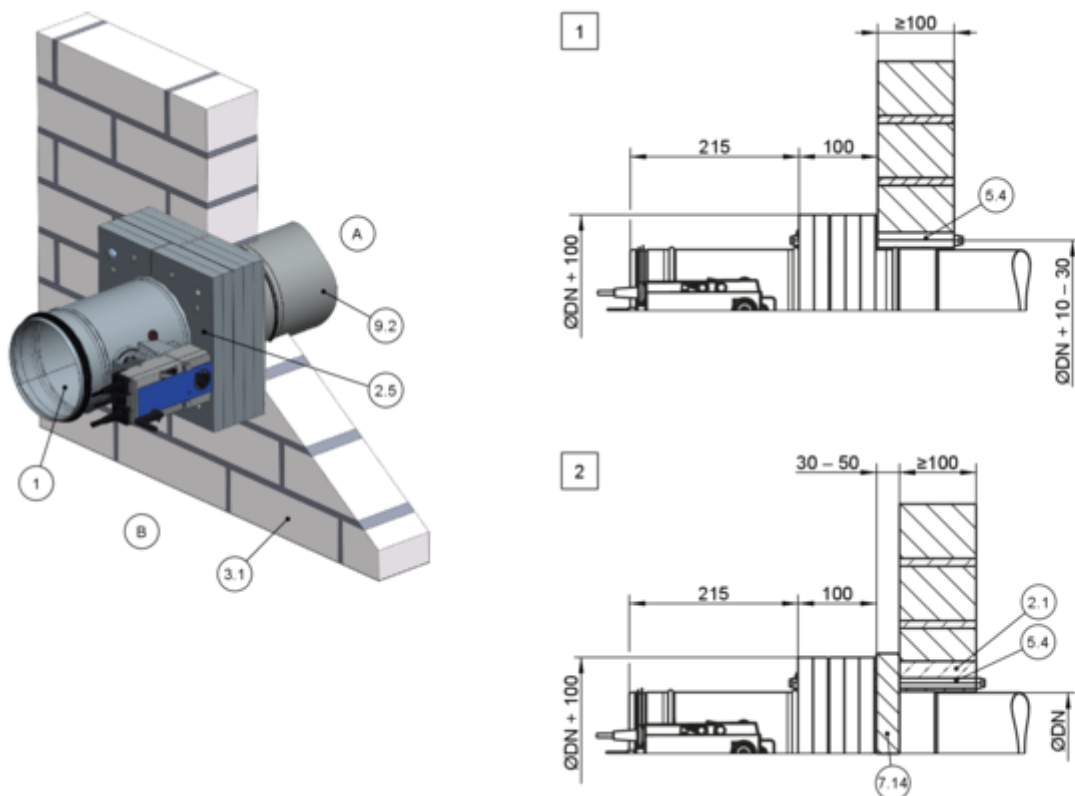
Installazione a secco senza malta in una parete piena, con kit d'installazione TQ2
